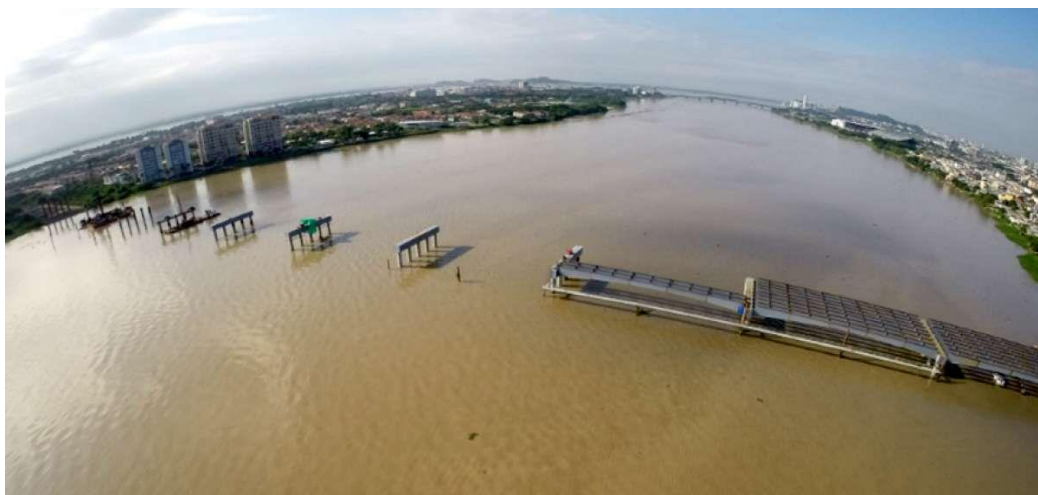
Construcción de las vigas metálicas del puente Guayaquil - Samborondón
